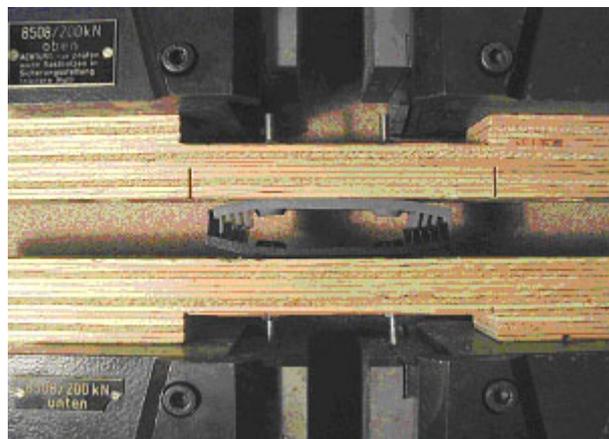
Essai de traction en laboratoire sur le système Jupit'air[®]
